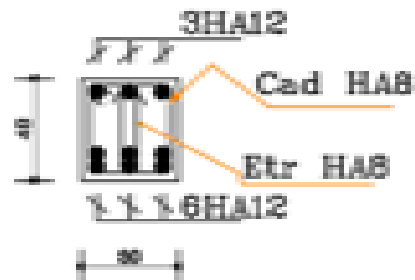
5.1 Schéma de ferrailage des poutres secondaires
